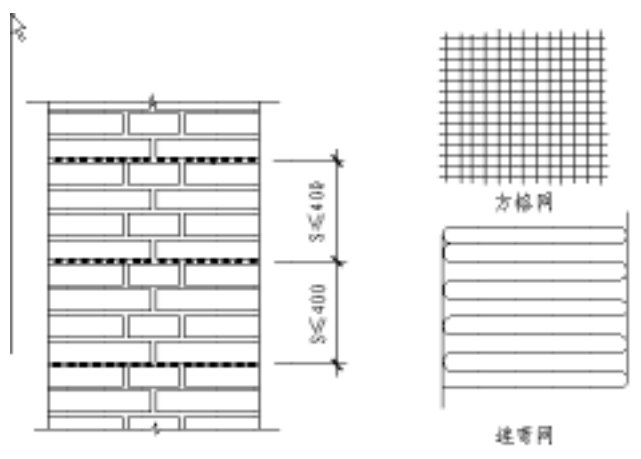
网状配筋砖柱(墙)构造做法
